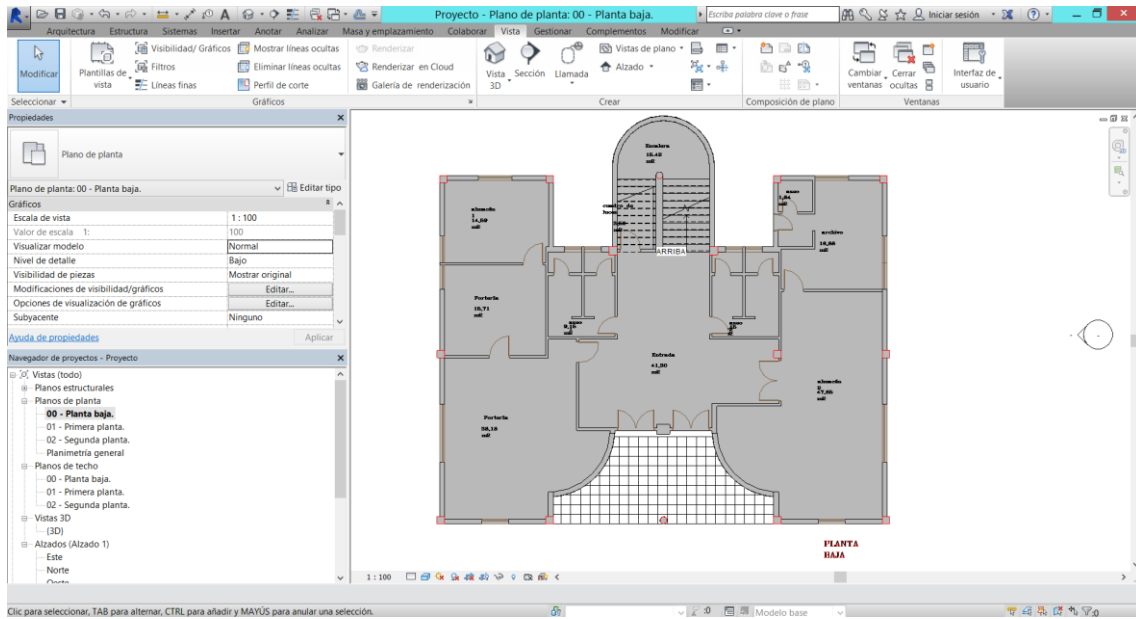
Escalera en la vista de planta: 00 - Planta baja. Fuente: Elaboración propia.
